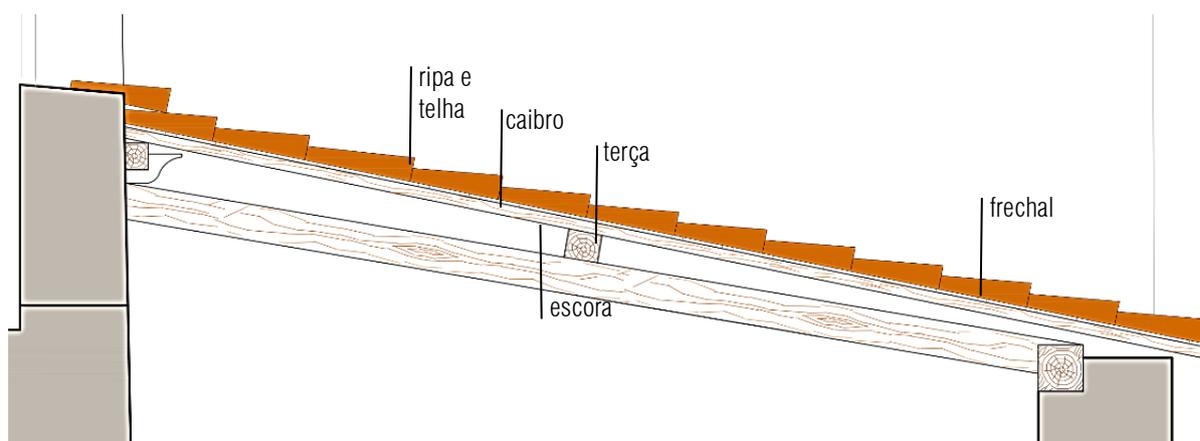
Estrutura de Madeira da cobertura – Nave Central
